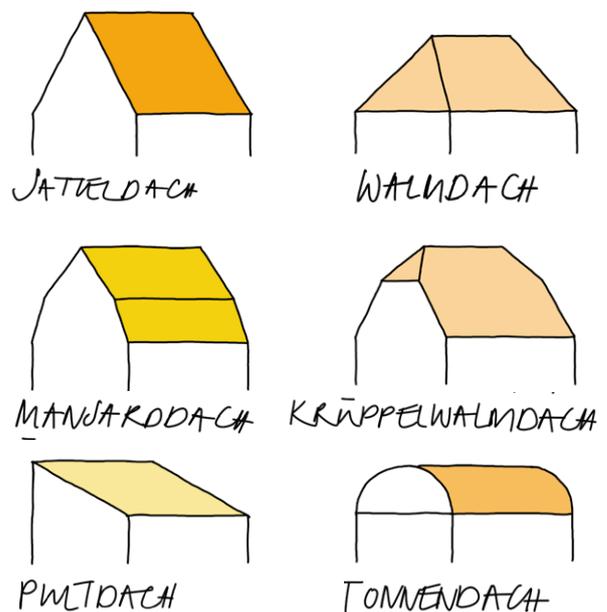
Lupe Baustruktur (Eigene Darstellung)
